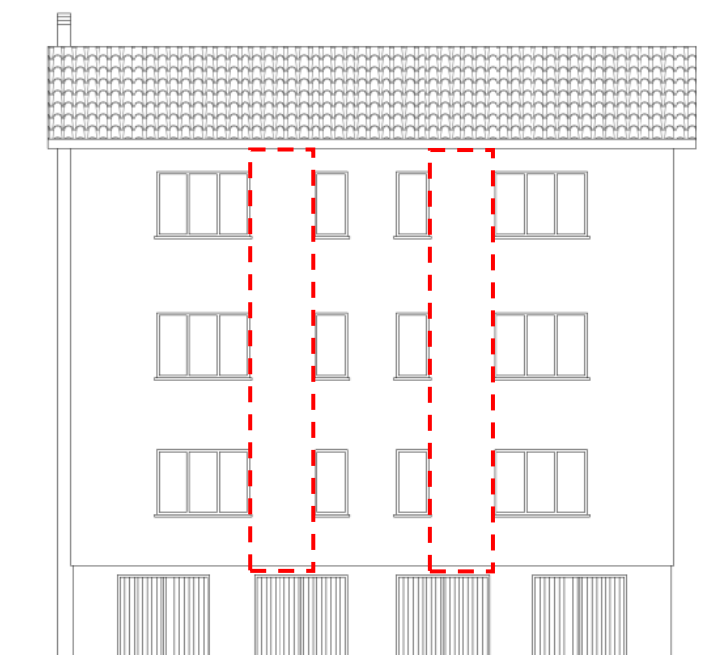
Vulnerabilità in elevazione: interruzione della continuità maschi murari nel prospetto nord.
